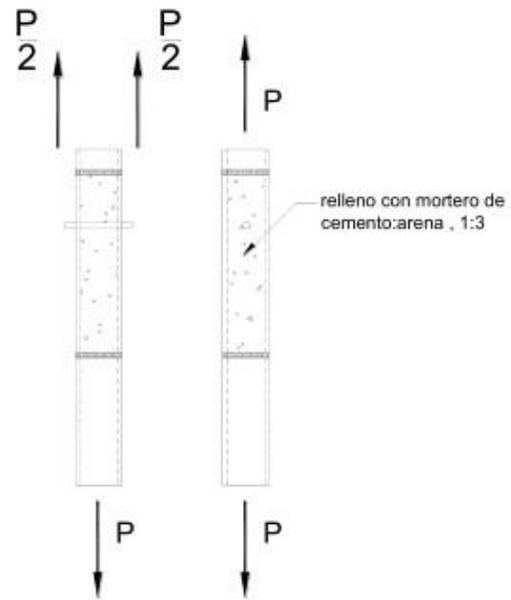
Unión de bambú con cargas a tensión paralelas a la fibra, tipo P
